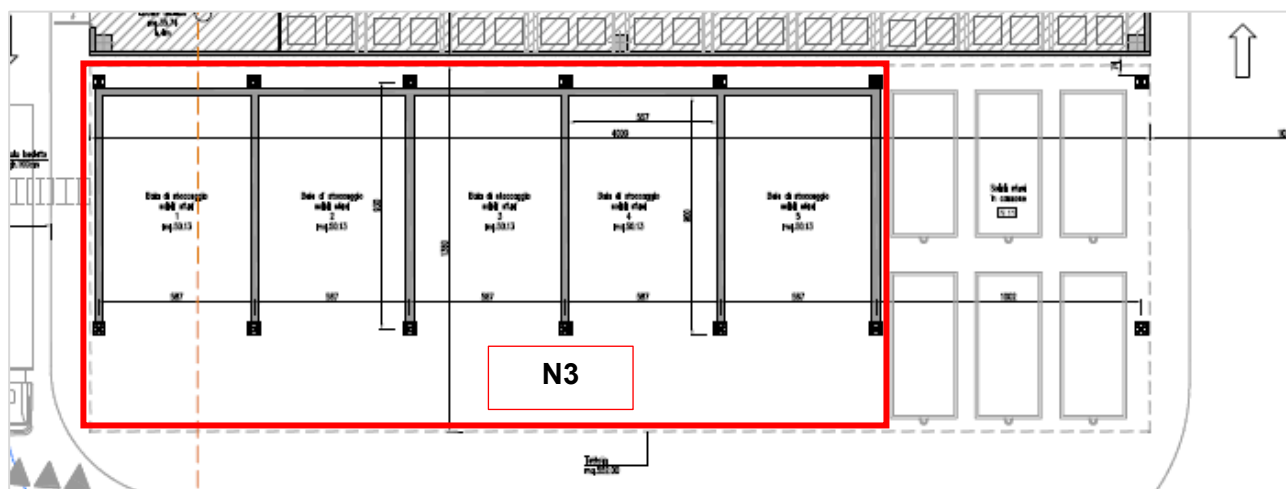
Dettaglio localizzazione Sezione N3 (stralcio elaborato CO 05 RA VA 01 D1 PL 68.00 - N3-N11 PIANTE)
